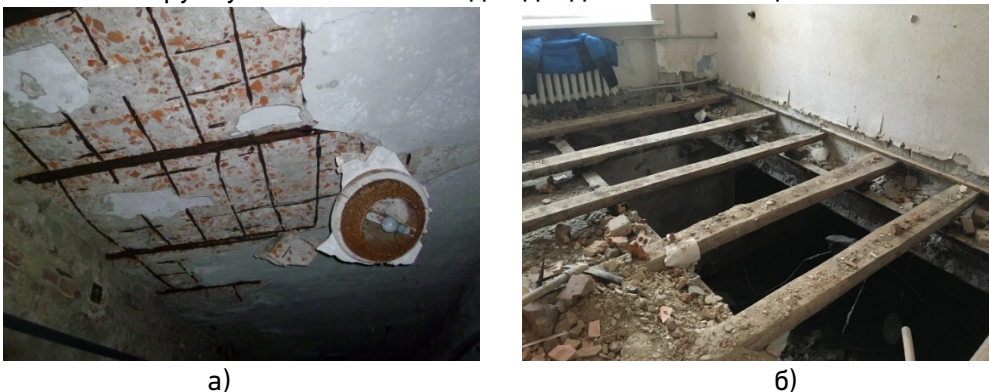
Фото перекриття над підвалом закладу охорони здоров'я у місті Полтава: а) руйнування захисного шару та кородування арматури цеглобетонного перекриття; б) обвал перекриття над підвалом
